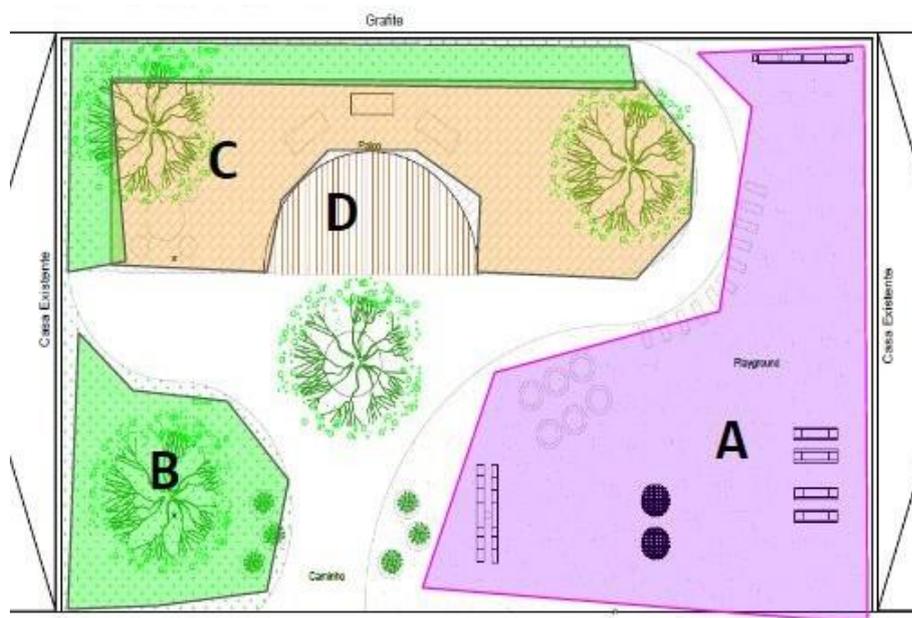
Planta esquemática de setorização. Fonte: Acervo do ECAUS, 2016.
